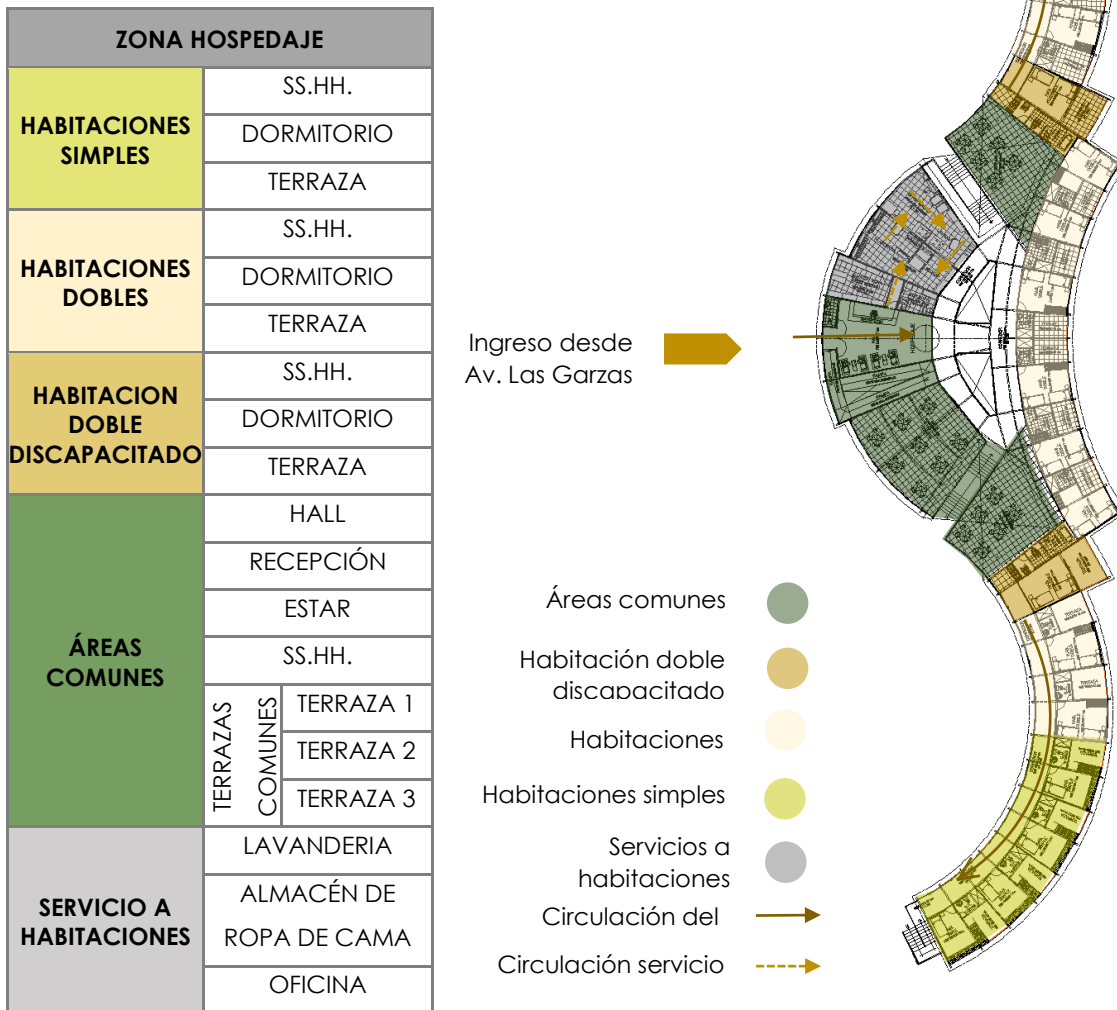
Layout de Zona Hospedaje-Primera Planta
